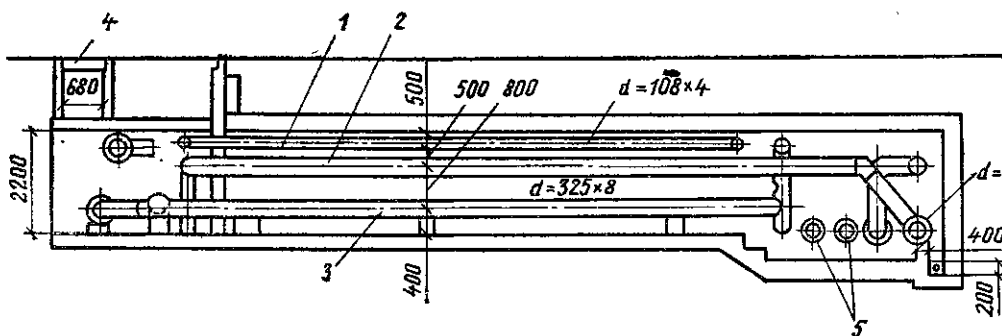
Схема укладки в туннеле водопроводных и технологических трубопроводов
